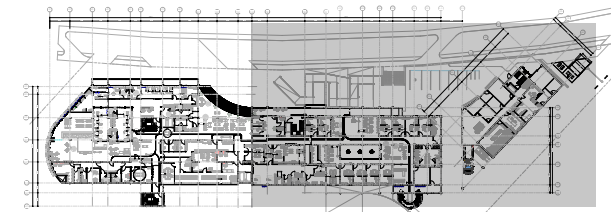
Planta de distribución arquitectónica nivel 0.00 m
